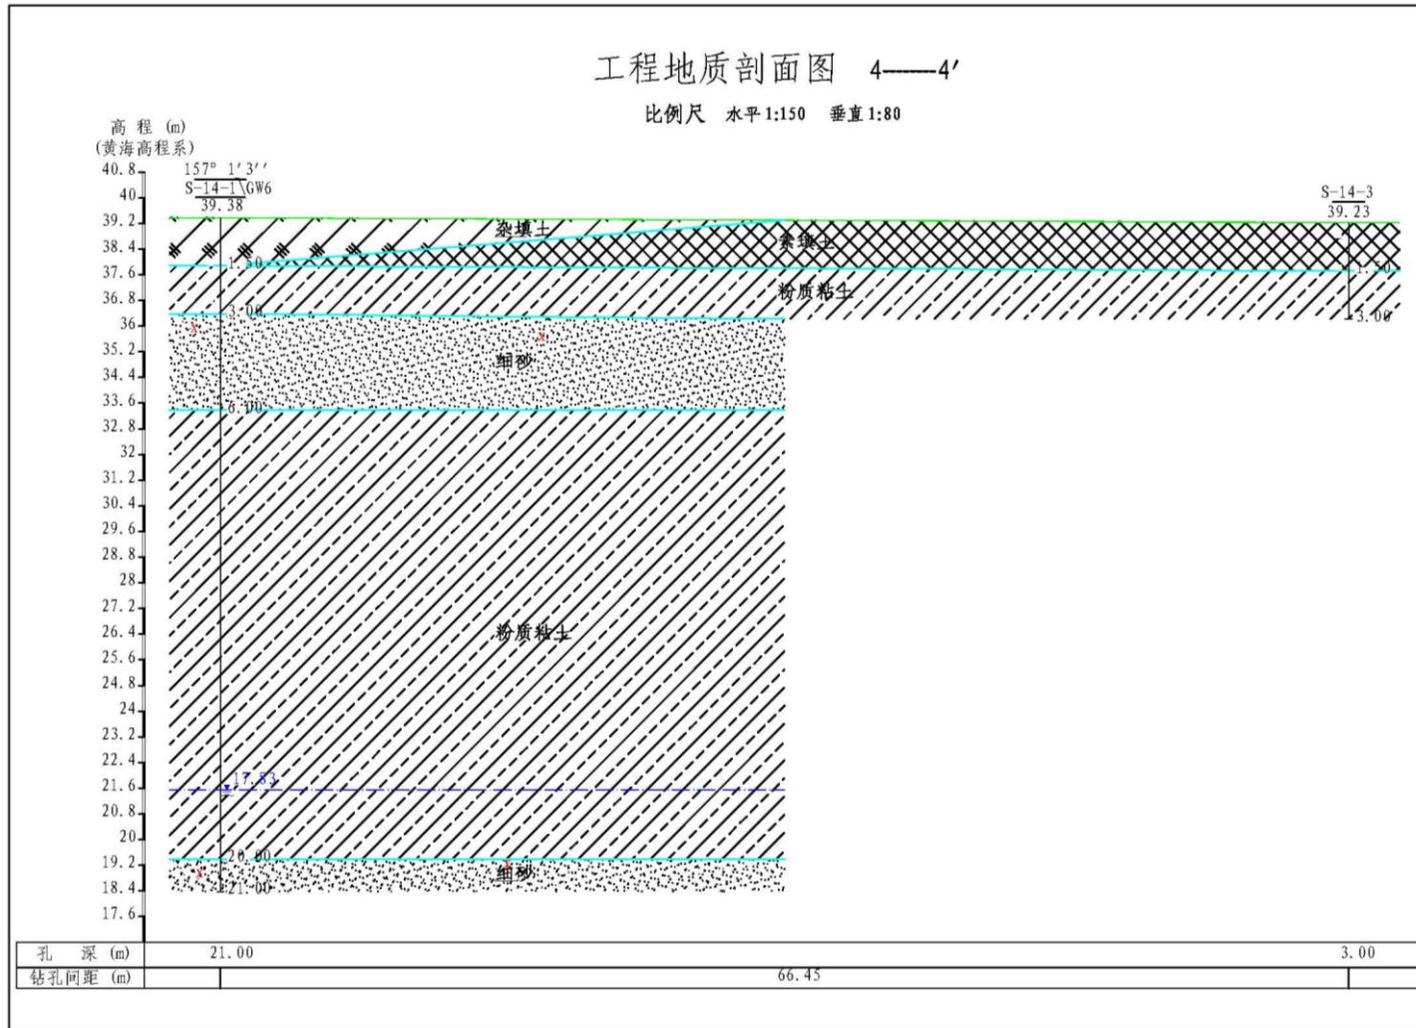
剖面线 4-4'地质剖面图 (纵向)
